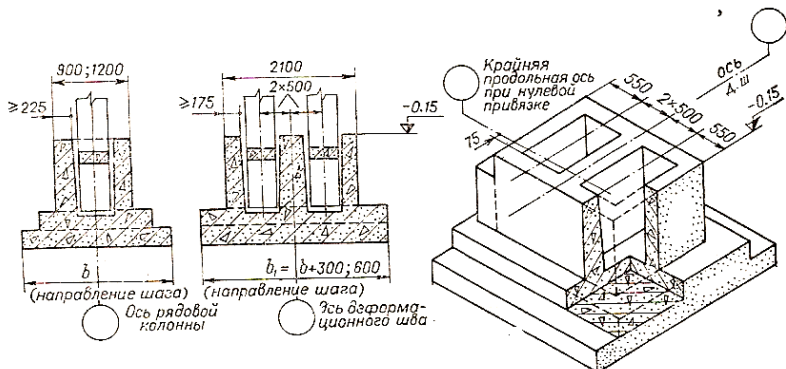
Монолитные фундаменты железобетонных колонн в местах устройства деформационных швов
